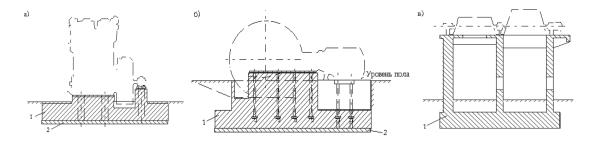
Примеры устройства фундаментов под машины: a- фундамент под вертикальный компрессор (плита в плане 3' 4,2 м); 6- фундамент под горизонтальный компрессор (плита в плане 4,4' 7,6 м, заглублена на 2,0 м); 8- стенчатый массивный фундамент под мотогенератор (расположен на высоте 6,3 м, размеры в плане  $4 \times 7,9$  м): 1- плита; 2- подготовка
